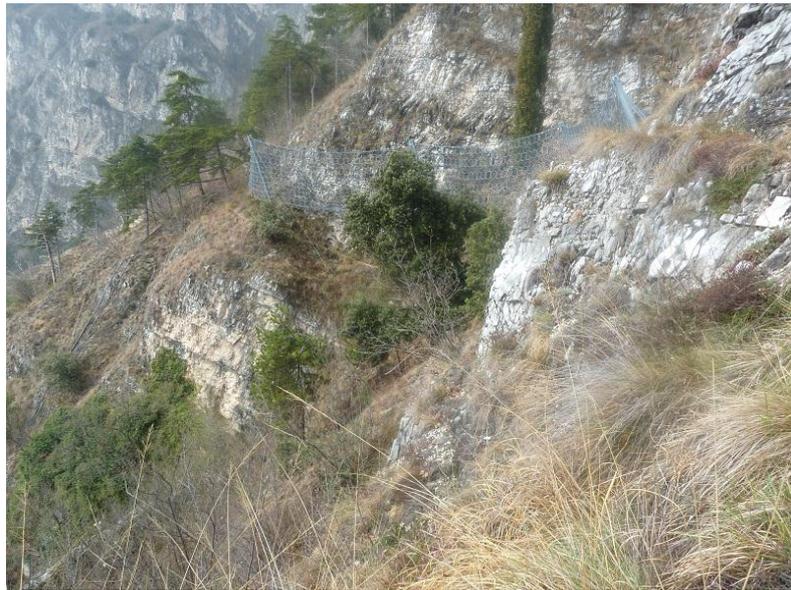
barriere paramassi a monte ex limonaia e lungo il versante
